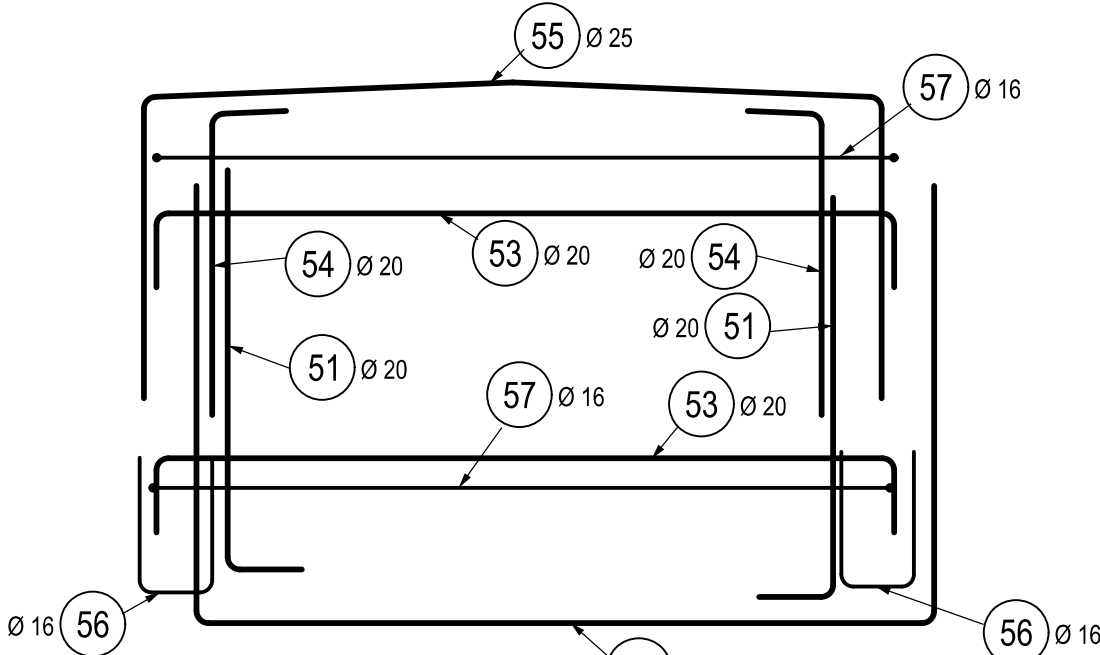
DETAIL VÝZTUŽE POD KOTVOU ZÁVĚSU, 1:25
